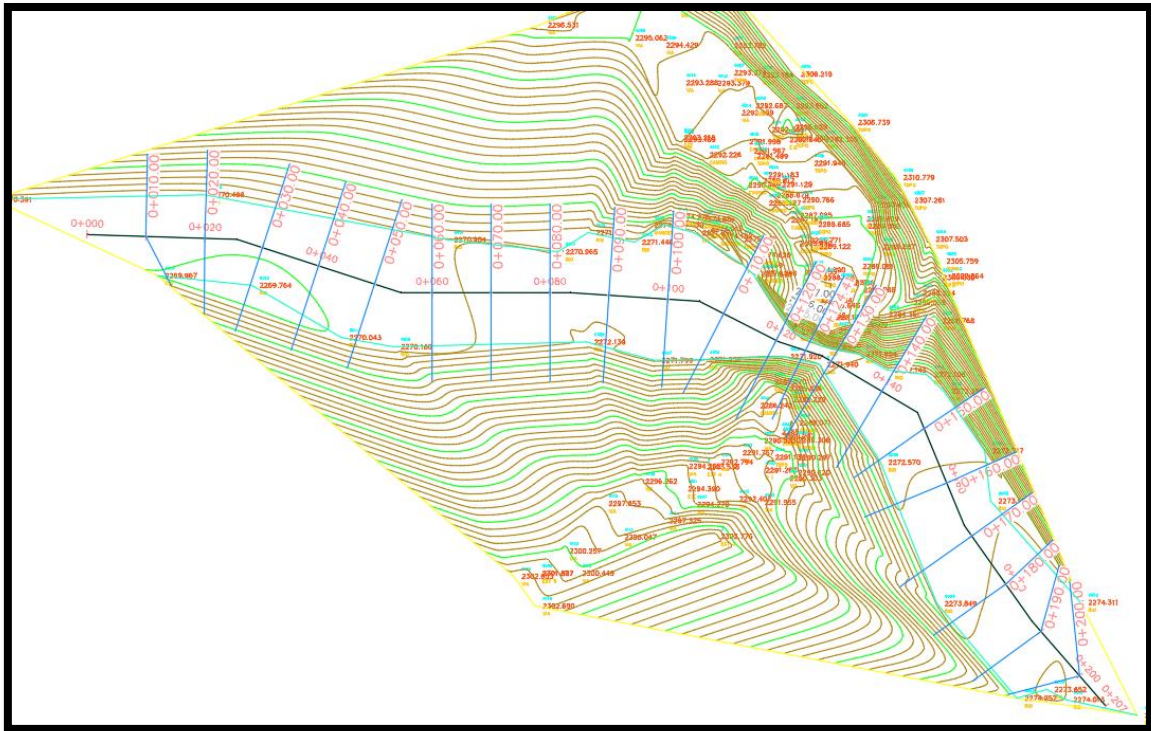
Secciones transversales del rio Collay. (Fuente, Autor).
